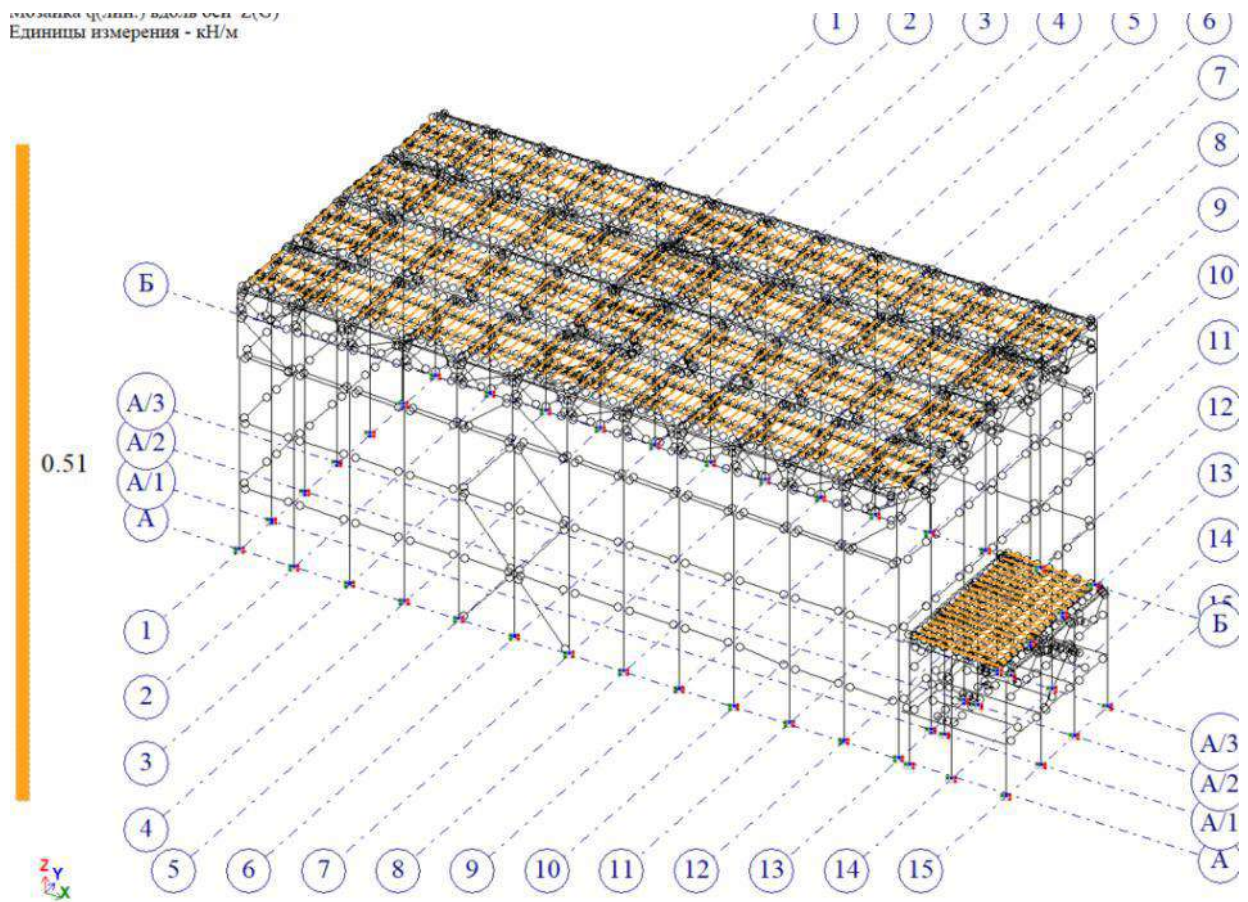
Нагрузка от веса промпроводок, кН/м
